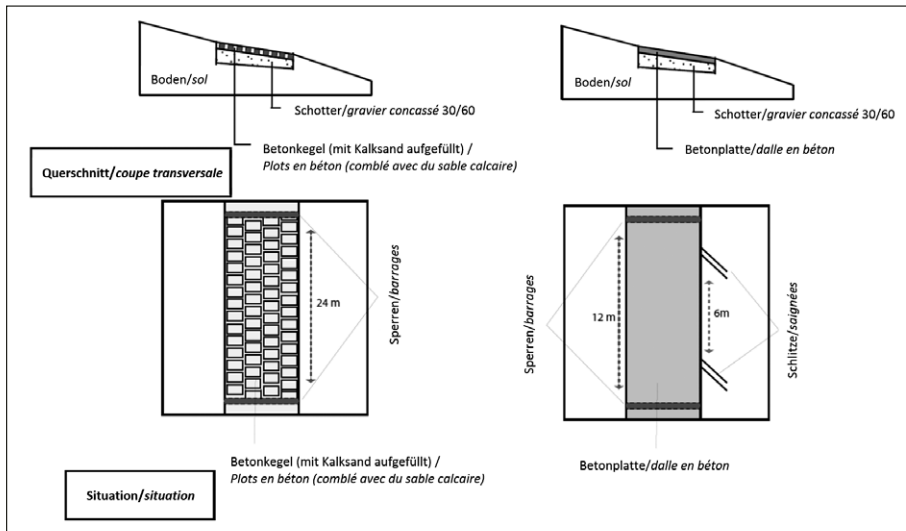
Schéma de construction des chemins en plots de béton (a) et en dalles de béton (b).
